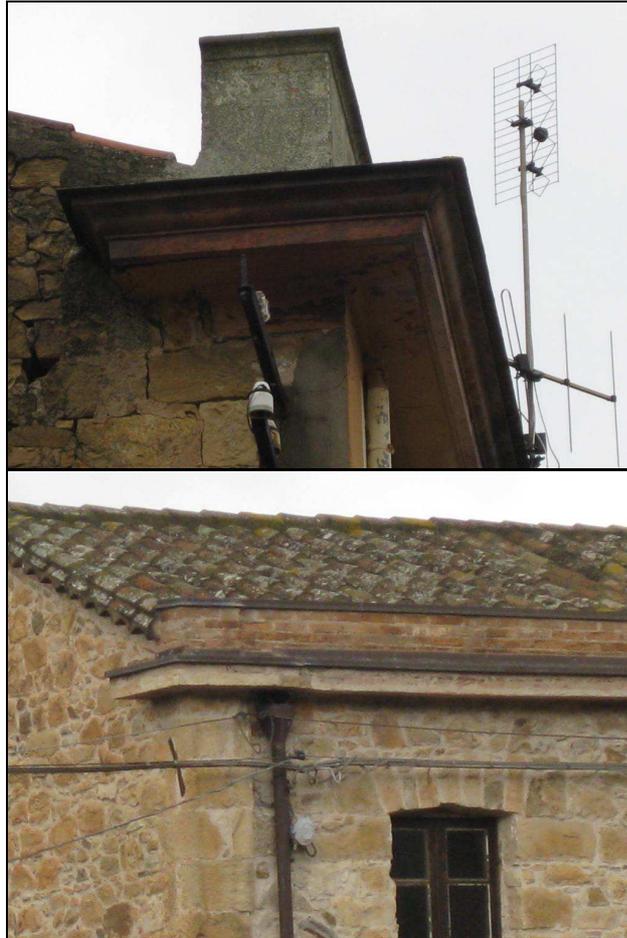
Canali di gronda con muretto d'attico e semplice cornice, smaltimento delle acque attraverso canale di raccolta, bicchiere e discendente laterale.
